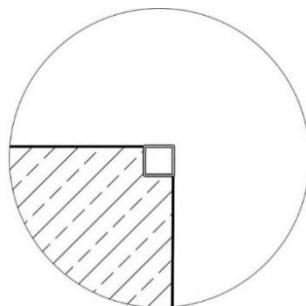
Profil równo „wtopiony” w krawędź elementu. Do profilu przyspawane marki z drutu stalowego w celu pewnego zakotwienia w betonie
